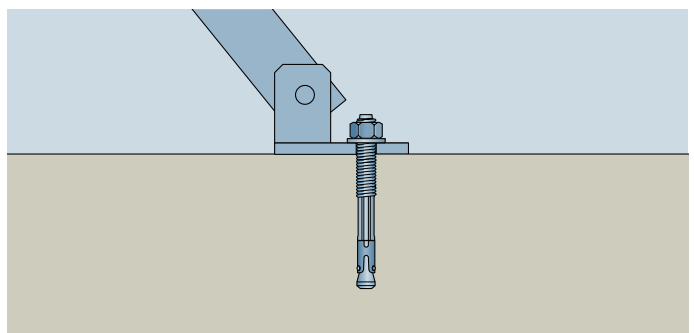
Montage Bolzenanker am Schrägstützenfuß
